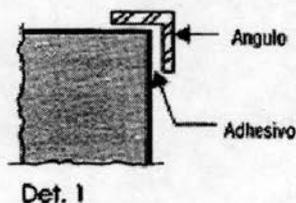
Columnas. Placas metálicas adheridas con resina epóxica
